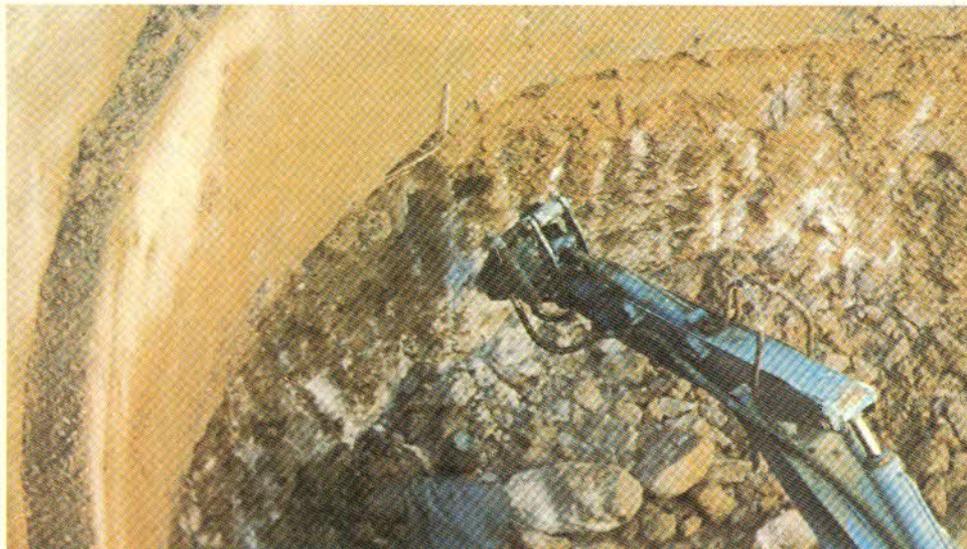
Scavo con «martellone» Atlas attraverso i grossi blocchi del pozzo n. 21 a 6 m di profondità □ The powerful Atlas hammer at work among the big boulders and pebbles of well no. 21, at a depth of 6 m
